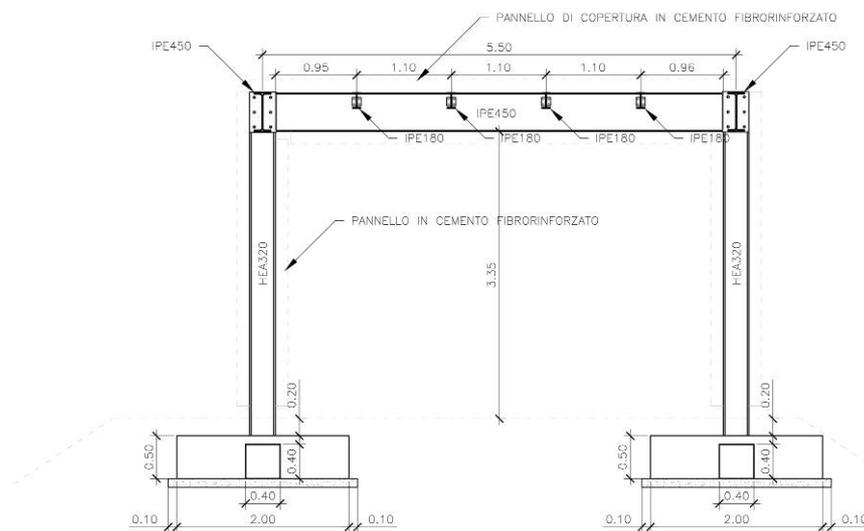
Sezione trasversale del tratto iniziale del camminamento pedonale
